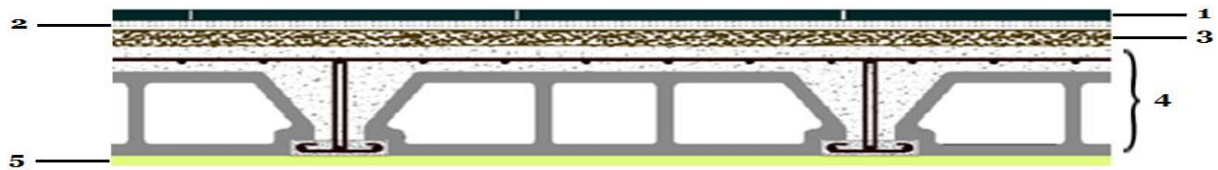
Coupe transversale d'un plancher à corps creux d'étage courant.
